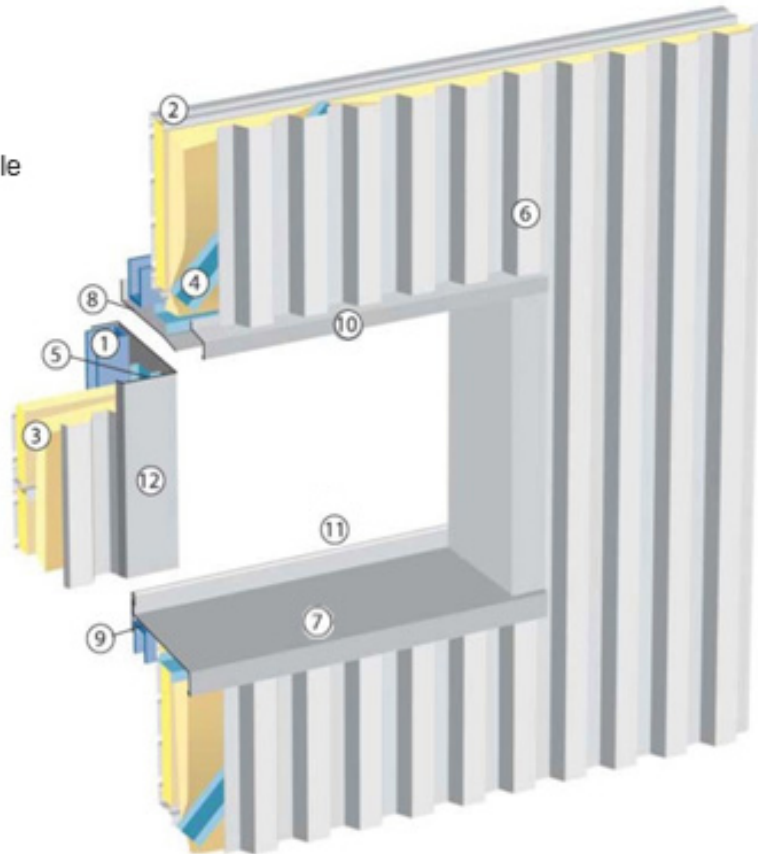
Detaj i bashkimit të paneleve për muraturë
